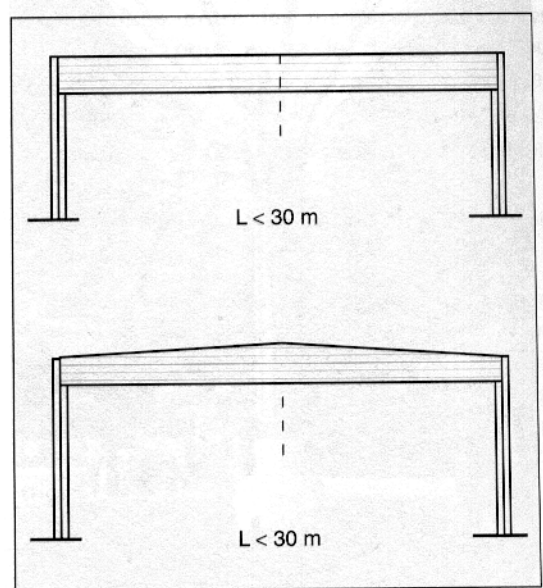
• Poutre sur appuis en bois lamellé-collé
